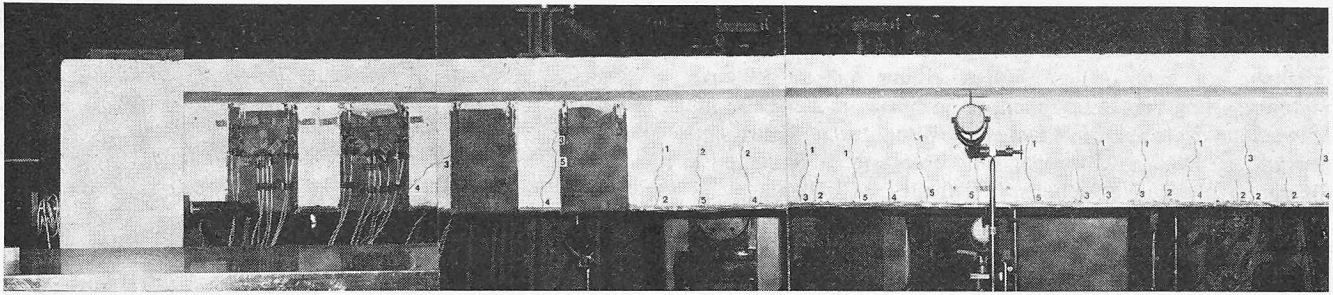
Plattenbalken mit Instrumentierung und Armierung. Links die Hälfte des Balkens mit dem festen Auflager, rechts Schnitt in Balkenmitte
